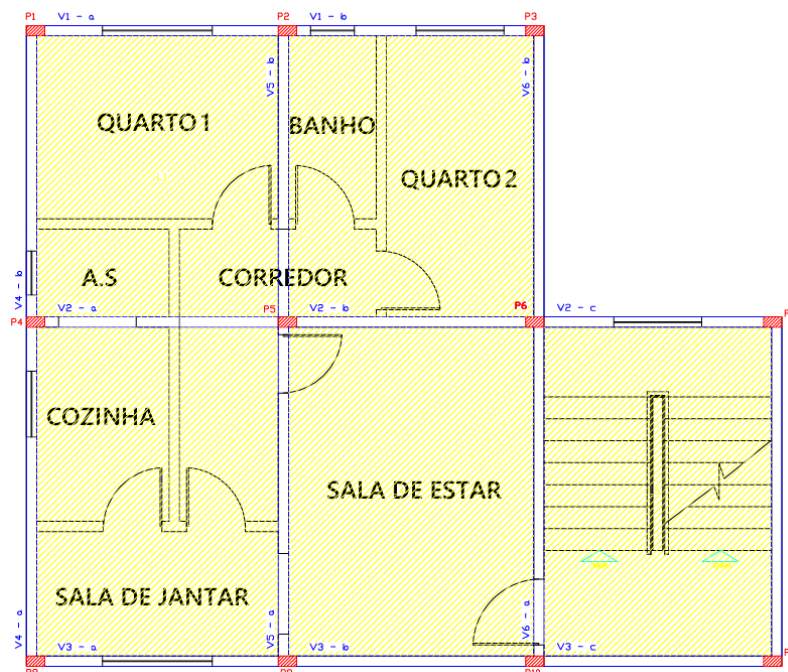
Planta Baixa do projeto com o lançamento das vigas
